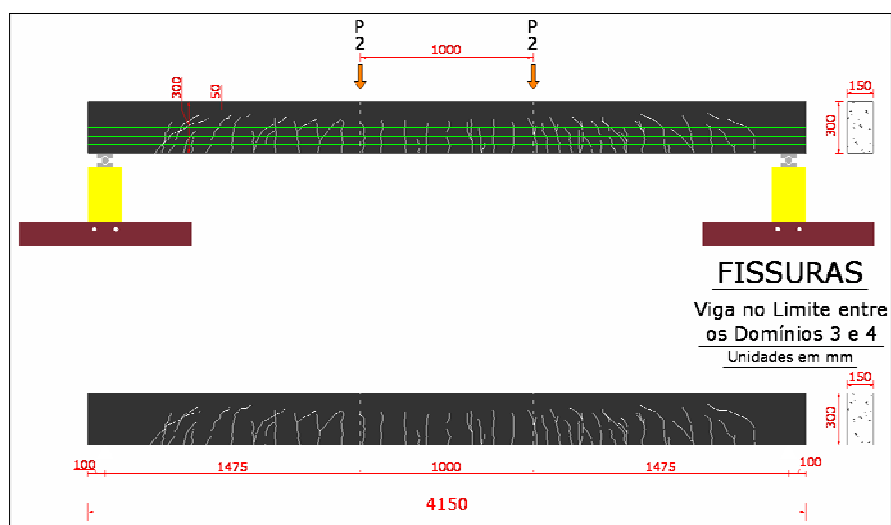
Cópia das fissuras ocorridas na viga ensaiada para o domínio 3-4.
